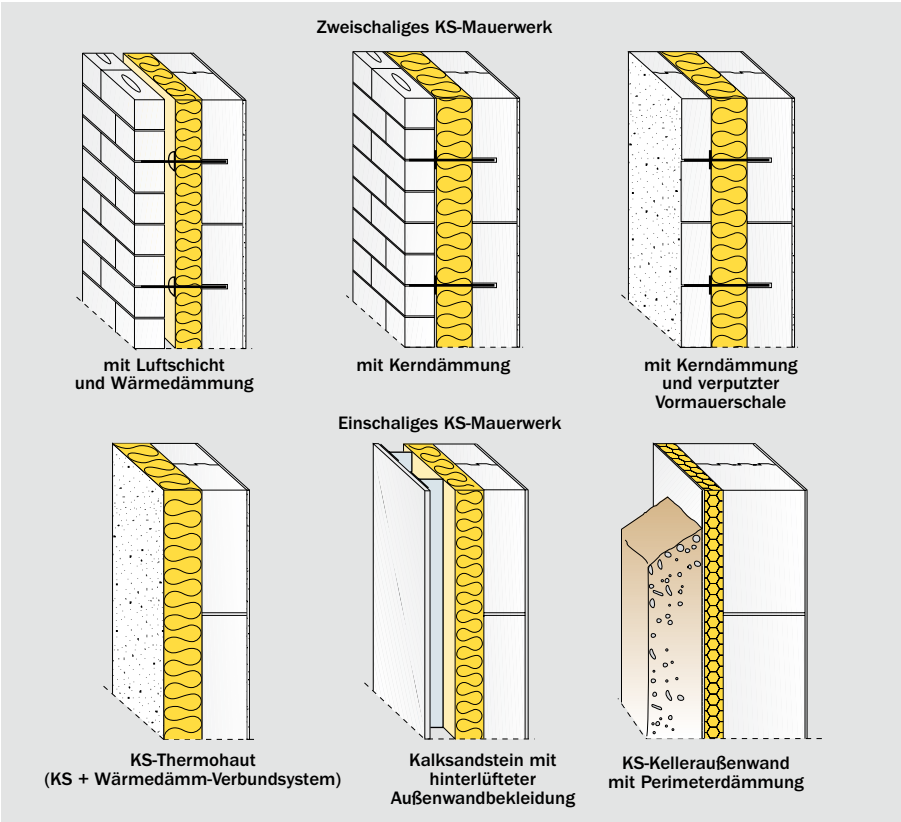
KS-Außenwandkonstruktionen für beheizte Gebäude
